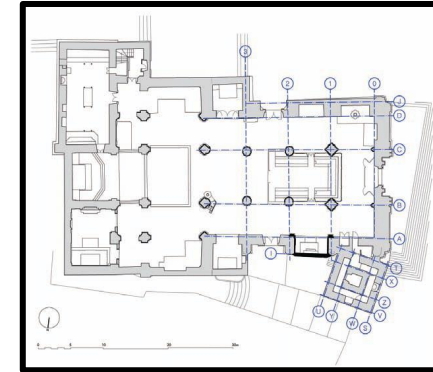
Planta arquitectónica de la Iglesia San Miguel de Morón. (N/A. 2008)
